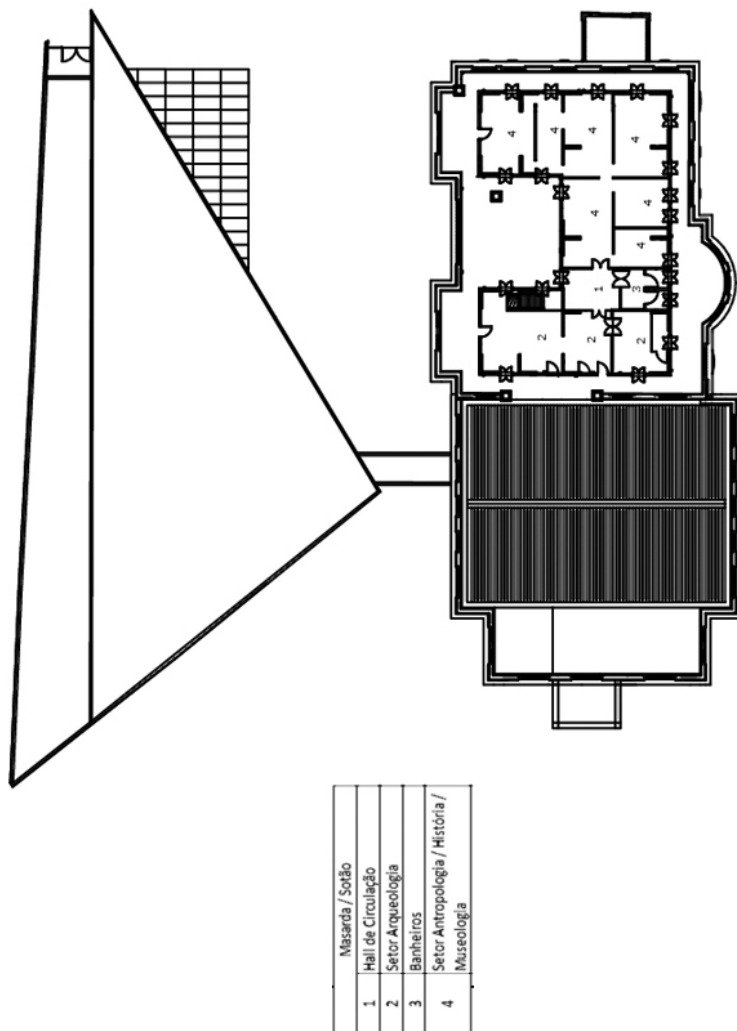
Planta baixa do sótão do Museu Paranaense.¹⁴⁸
